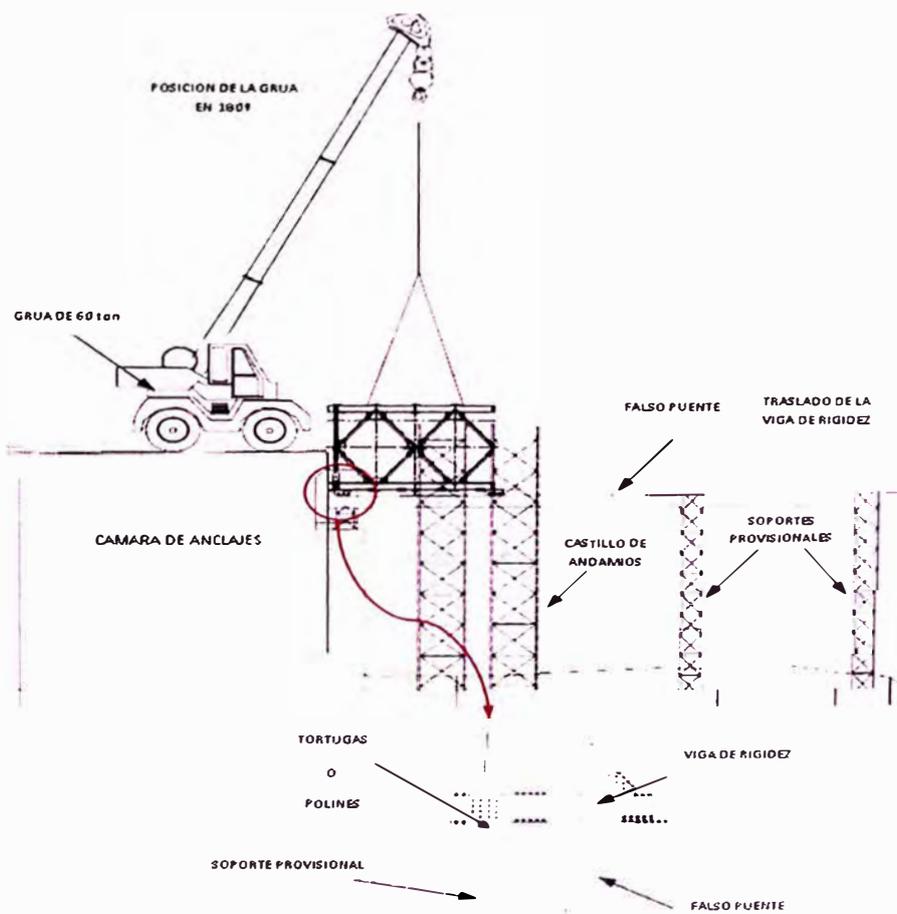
UBICACIÓN DE LA VIGA DE RIGIDEZ EN EL FALSO PUENTE
